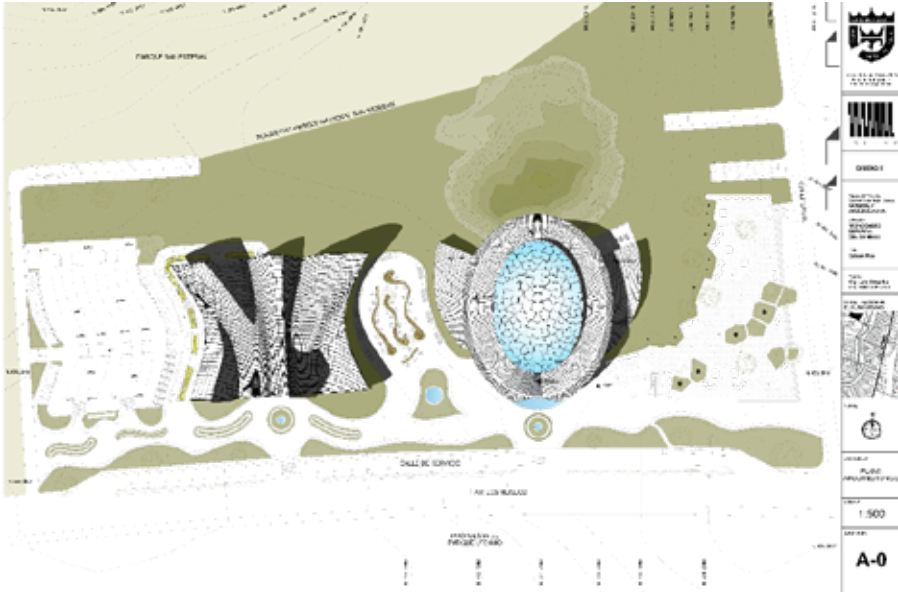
Planta Techo Conjunto. Fuente: Autor (2021)
